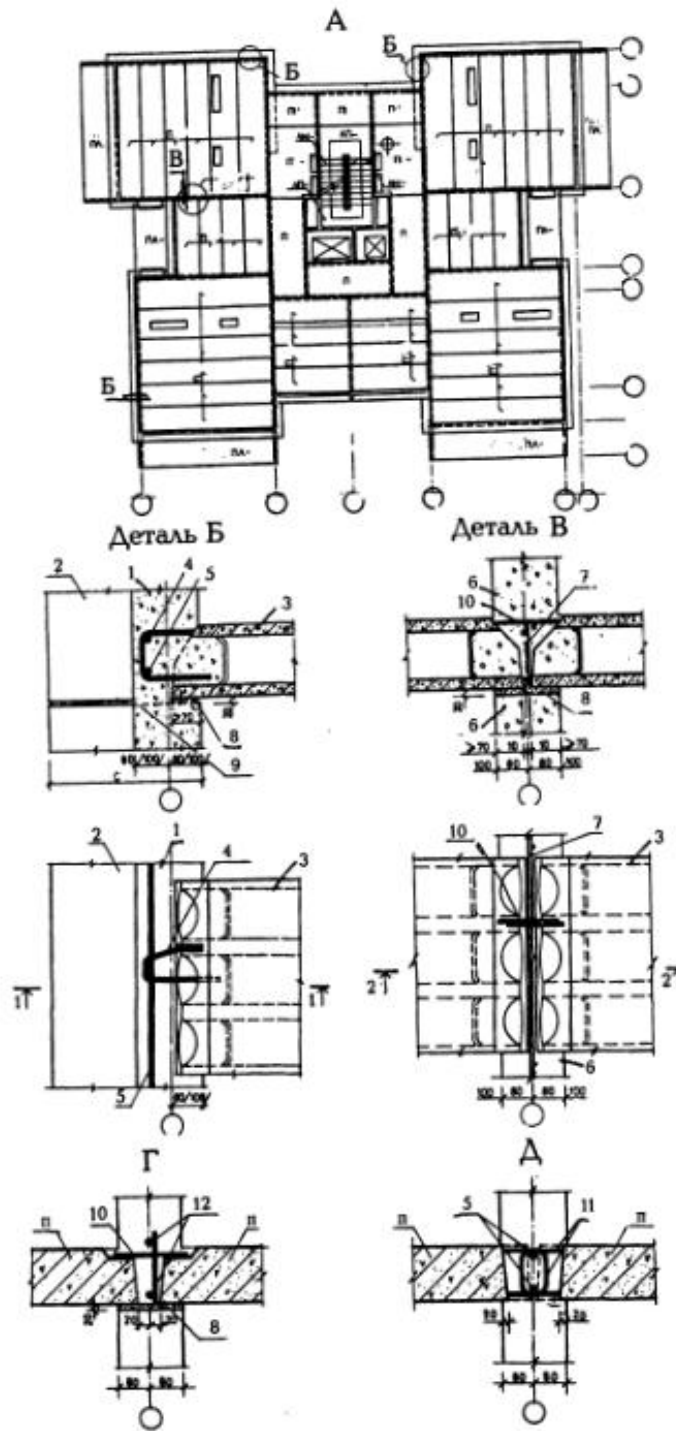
Сборное перекрытие из железобетонных плит: А - монтажный план плит перекрытий; Б - деталь опирания многопустотного настила перекрытия на монолитную наружную стену; В - то же, на внутреннюю стену; Г - деталь опирания плит перекрытия сплошного сечения со сварными связями на внутреннюю монолитную стену; Д - то же, с замонтированными петлевыми связями; 1-П - плита перекрытия; ПЛ - плита лоджии; ЛП - плита лестничной площадки; ЛМ - лестничный марш; 1 - монолитный слой наружной стены; 2 - утепляющая сборная скорлупа; 3 - плита перекрытия; 4 - анкер; 5 - анкерный стержень; 6 - монолитная внутренняя стена; 7 - арматурный каркас; 8 - цементный раствор; 9 - уровень бетонирования; 10 - сварная связь; 11 - петлевой выпуск; 12 - арматурный каркас.
